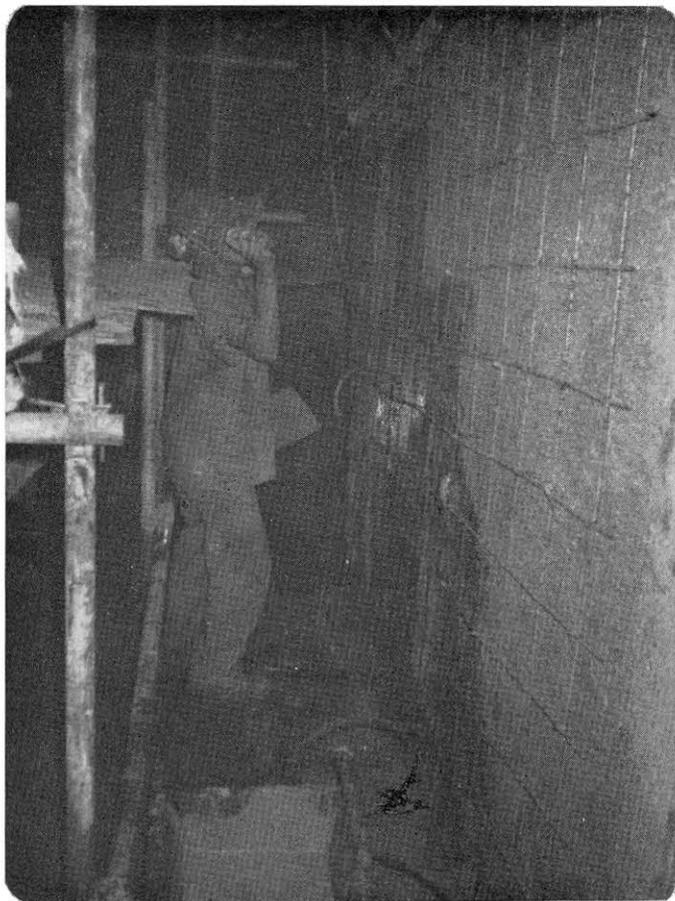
Aplicación de adhesivo epoxi sobre la armadura y hormigón «viejos». Anteriormente la pared se preparó con la limpieza de los puntos de corrosión y chorreamiento de arena. Posteriormente se aplicará hormigón o mortero «nuevo» sobre el producto adhesivo (gentileza de Ciba-Geigy).
